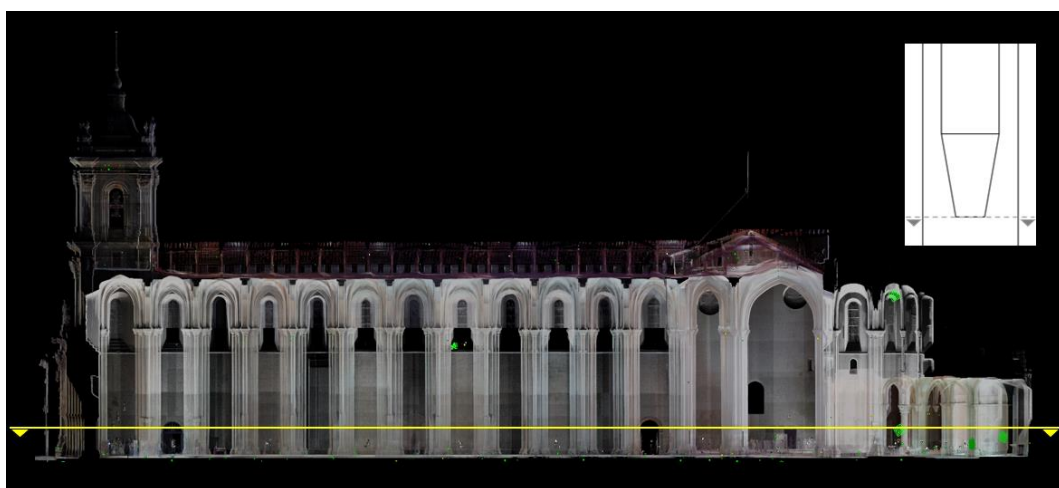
Demonstração do corte em planta pela base das mísulas piramidais dos pilares da Igreja.
